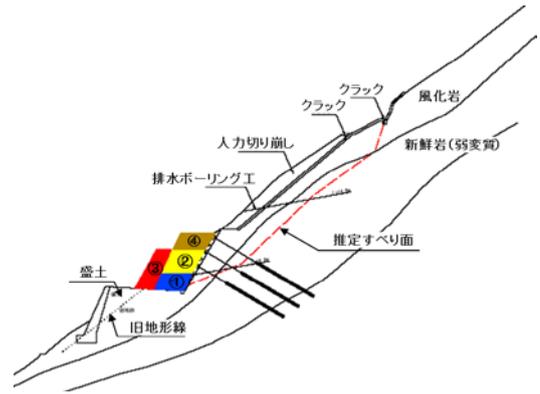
No.8地すべりの押え盛土工施工図(縦断面図)
